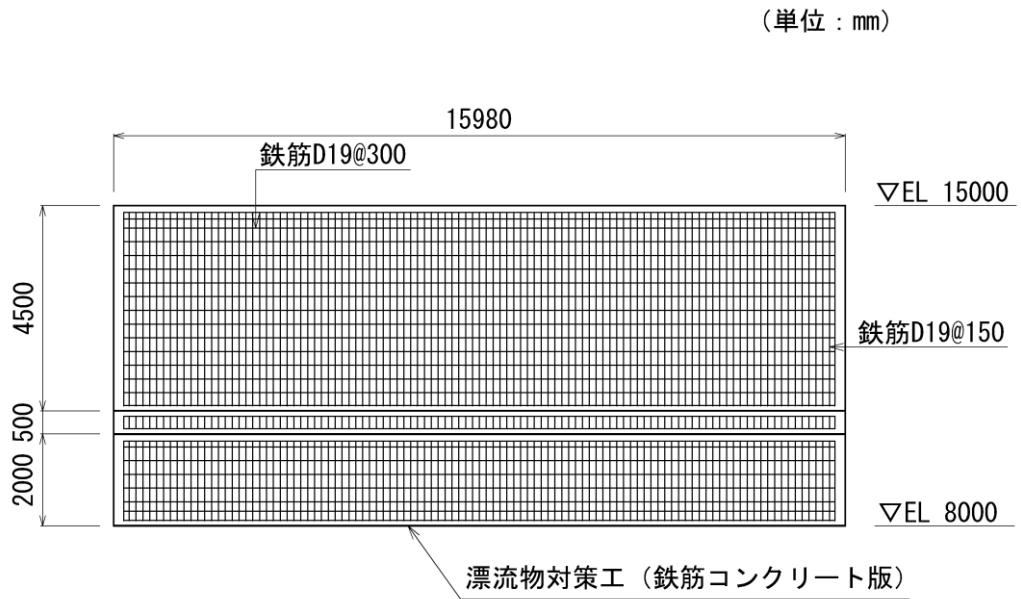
(1) 漂流物対策工 (鉄筋コンクリート版) の概略配筋図 (正面図)
